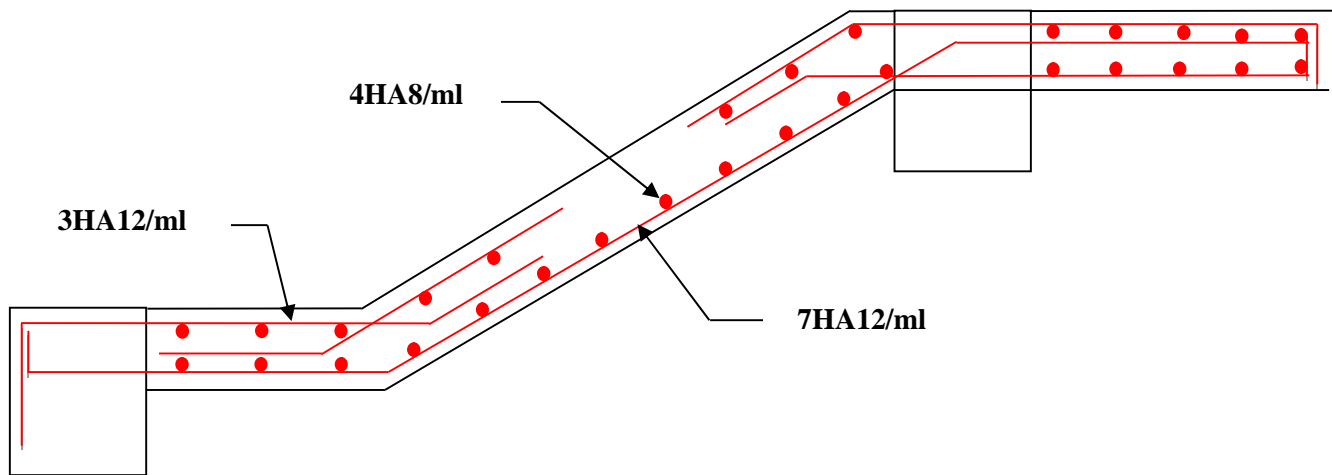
Schéma de ferrailage de l'escalier à deux volées.
